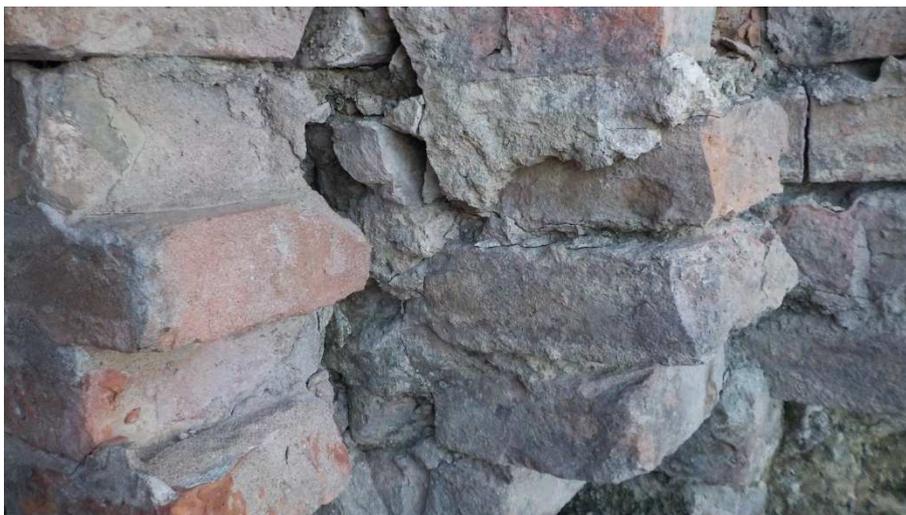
porzione di muratura con distacco della testa più esterna – particolare
